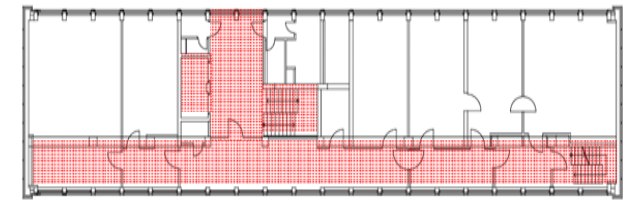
Regelgeschoss - Grundriss 7.OG
